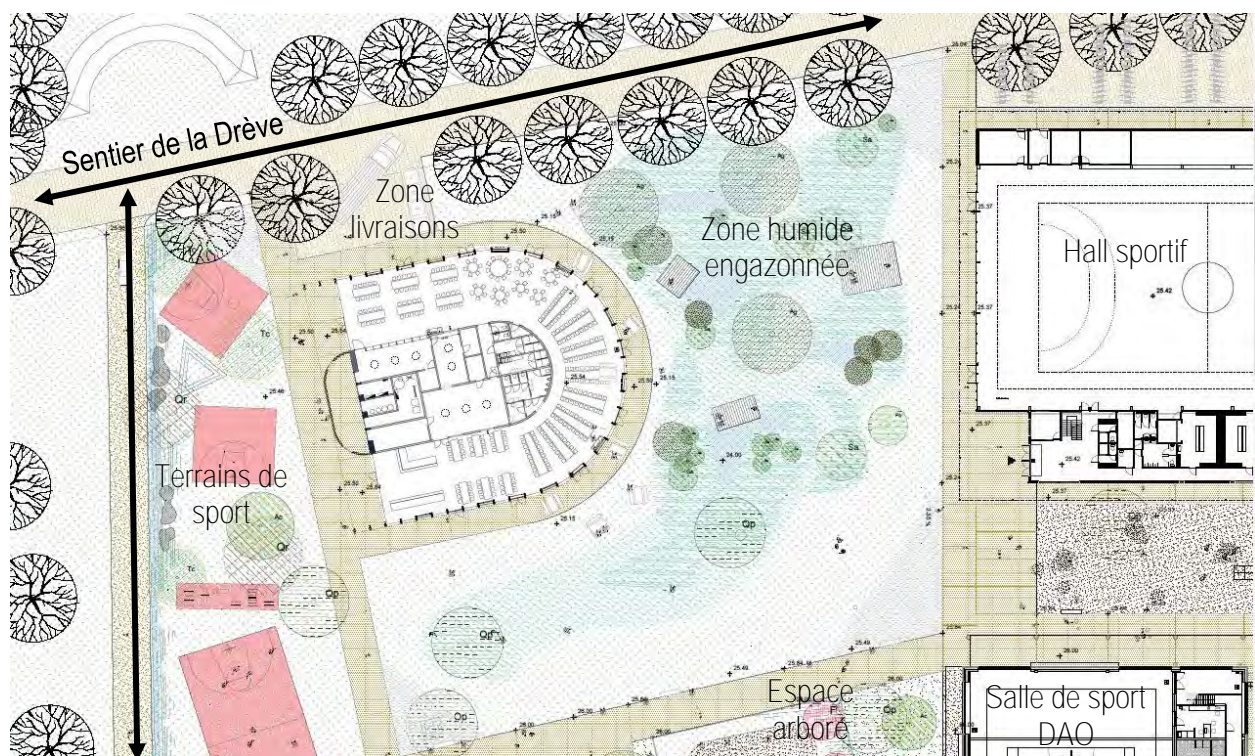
Plan d'implantation du Pavillon Restaurant
